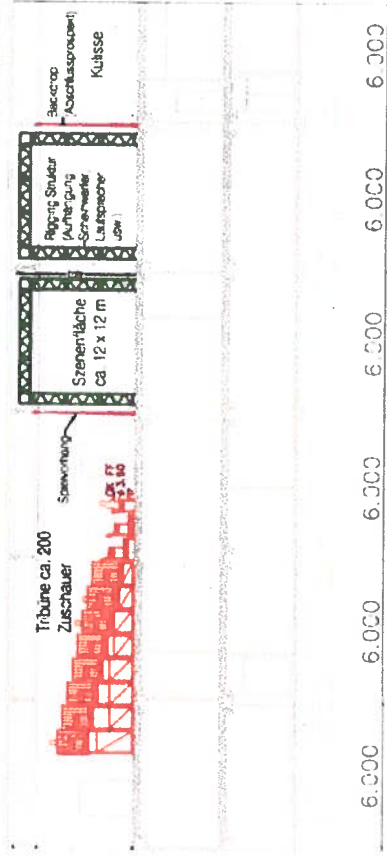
Mensa am Wall - Schnitt mit Spielstätte im großen Speisesaal
